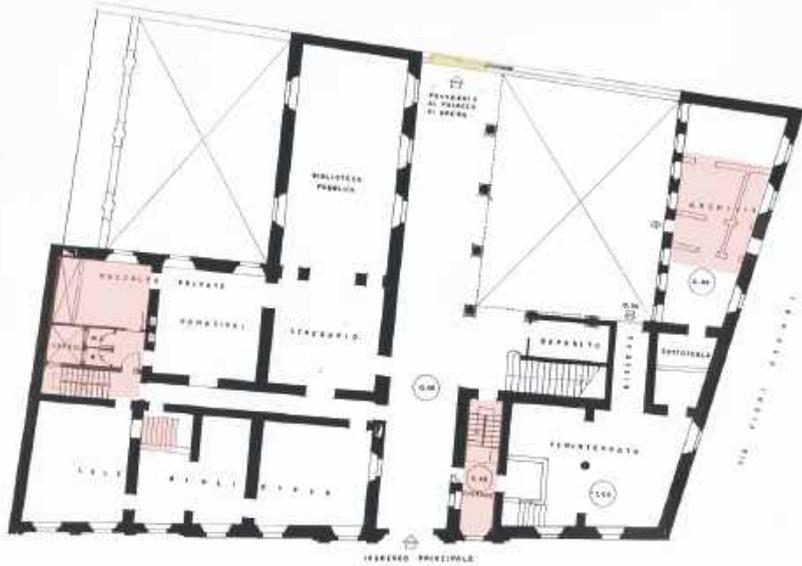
Pianta piano terra, progetto di sistemazione (rielaborazione, rosso-nuovi interventi)
